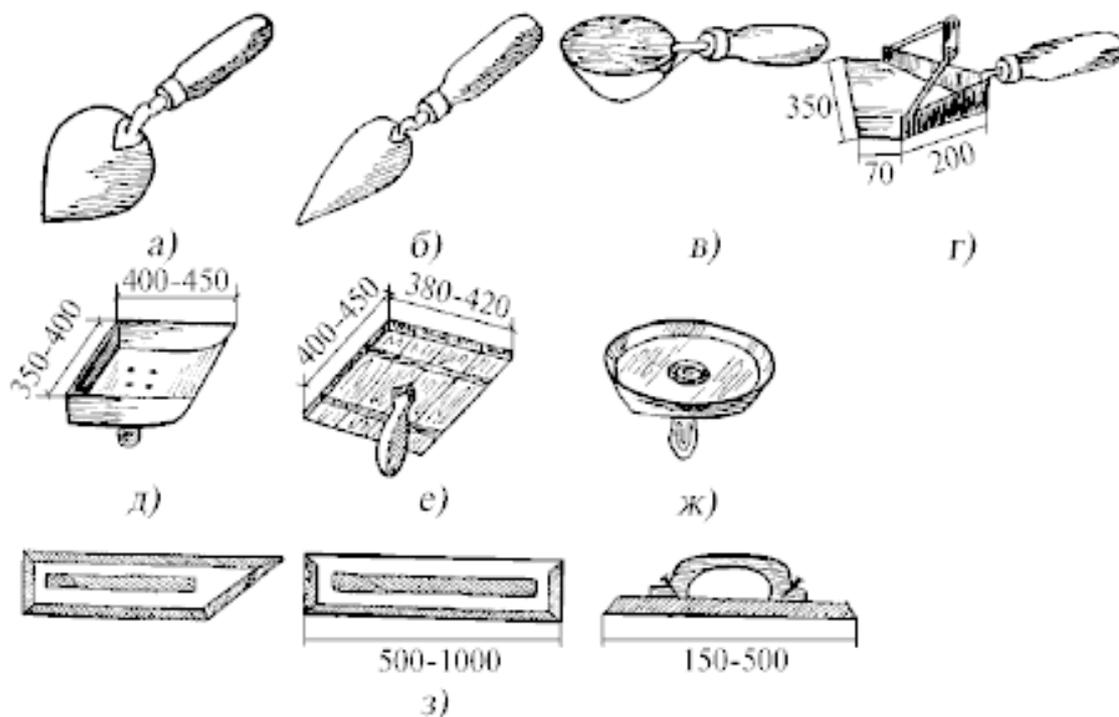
Инструменты для нанесения и разравнивания раствора: а) штукатурная лопатка; б) отрезовка; в) ковш; г) совок с качающейся ручкой; д) совок-ковш; е) прямоугольный сокол; ж) тарельчатый сокол; з) полутерки
